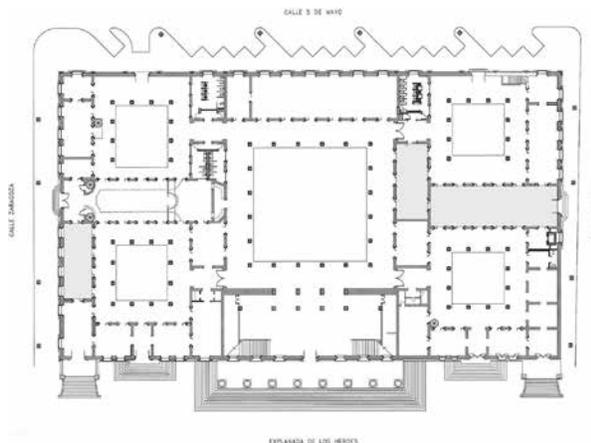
Salones con el mosaico de cubos tridimensionales. Plano de la planta baja del Palacio de Gobierno de Nuevo León. Arquitecta Isabel Agueda. Agradecemos a la arquitecta Isabel Agueda nos haya proporcionado el plano de la planta baja del Palacio de Gobierno de Nuevo León.
